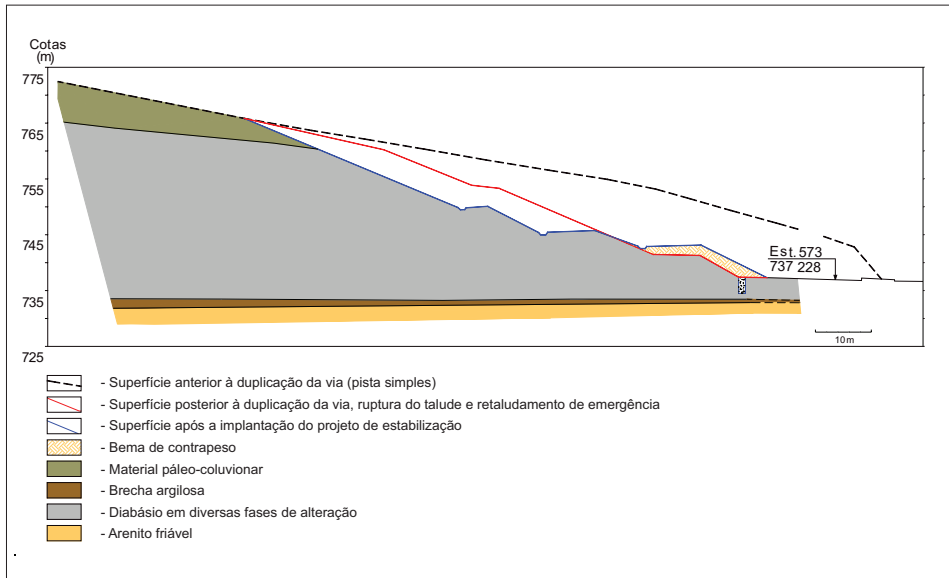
Seção geológica de projeto pelo eixo do escorregamento. (Figura do Autor)
